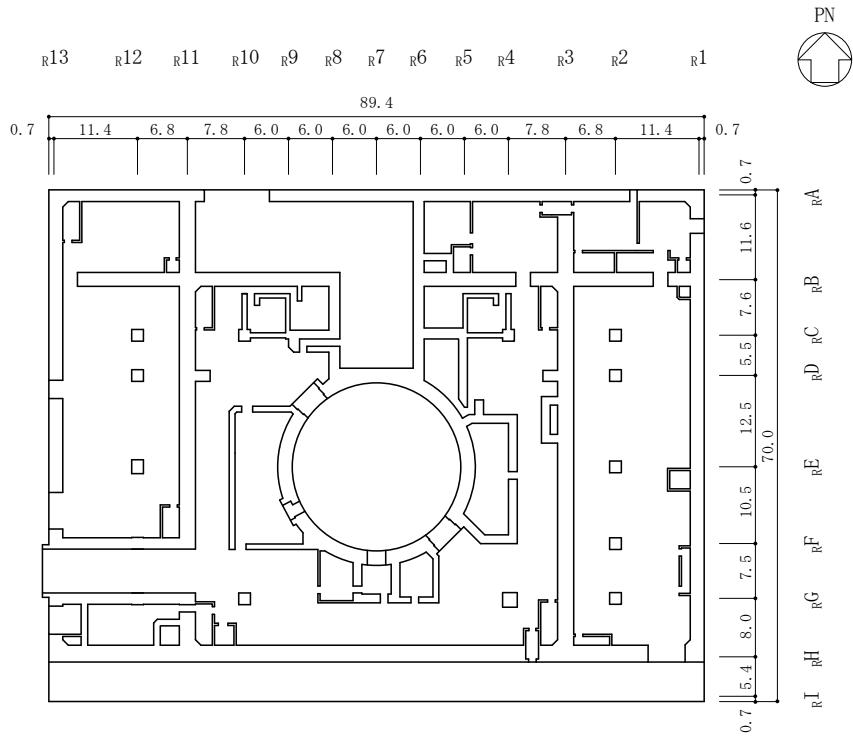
(1) 原子炉建物の概略平面図 (EL 1.3m*)
